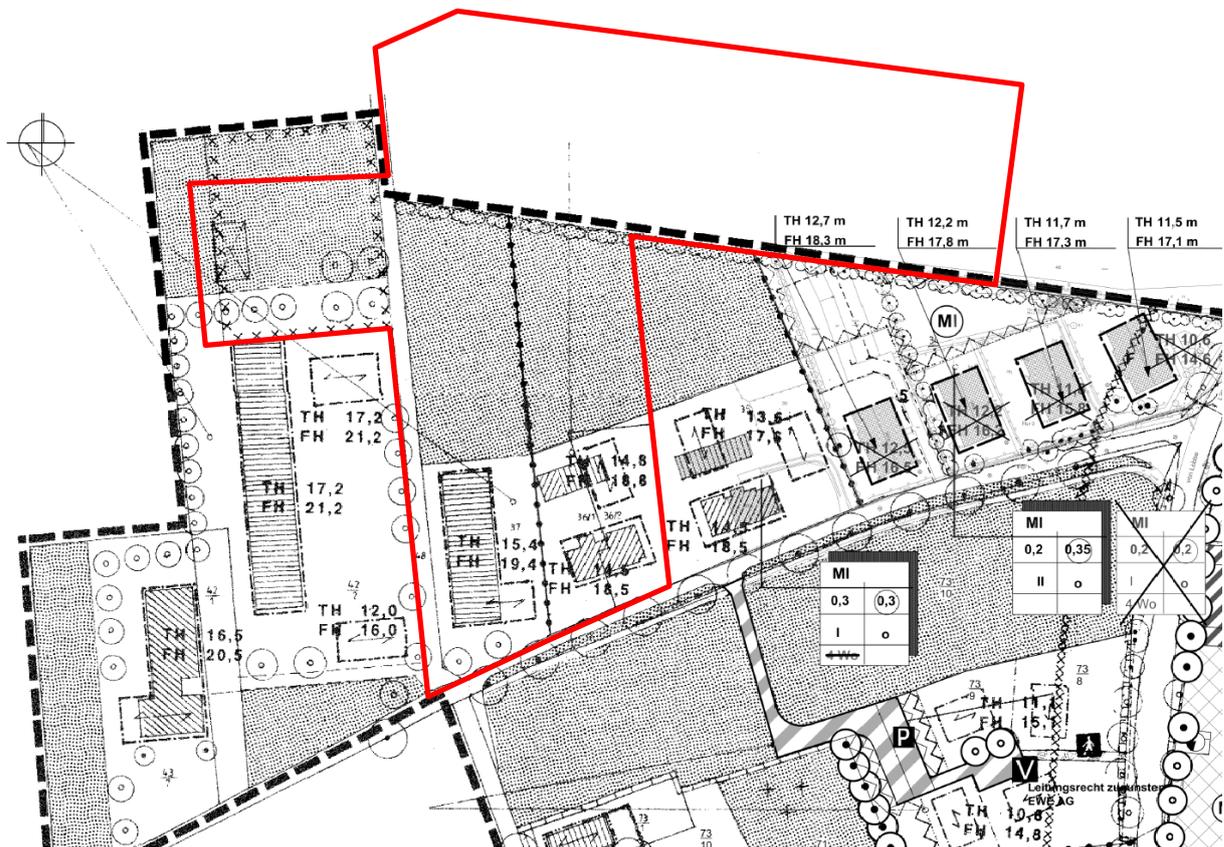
Ursprungsplan in der für die Planung relevanten Fassung der 2. Änderung mit Geltungsbereich der 6. Änderung, ohne Maßstab
